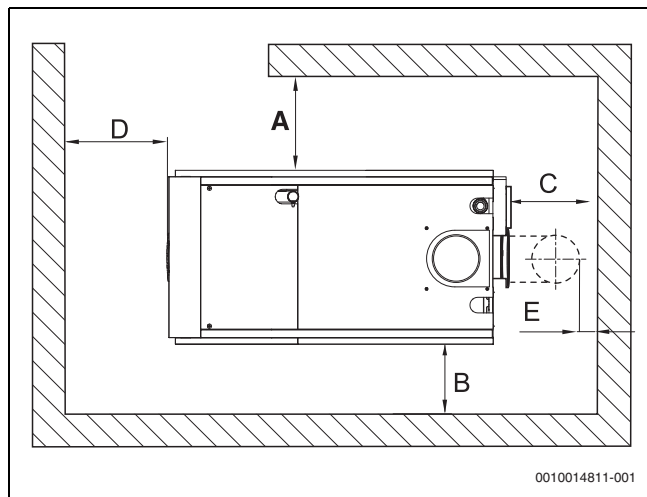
Distanze dalle pareti nel locale di posa (versione sinistra, caldaia singola)
